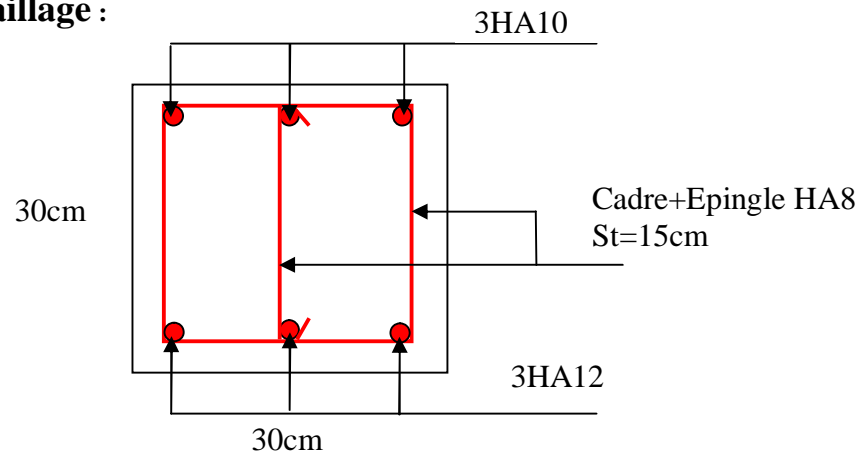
Schéma de ferrailage de la poutre de chaînage
